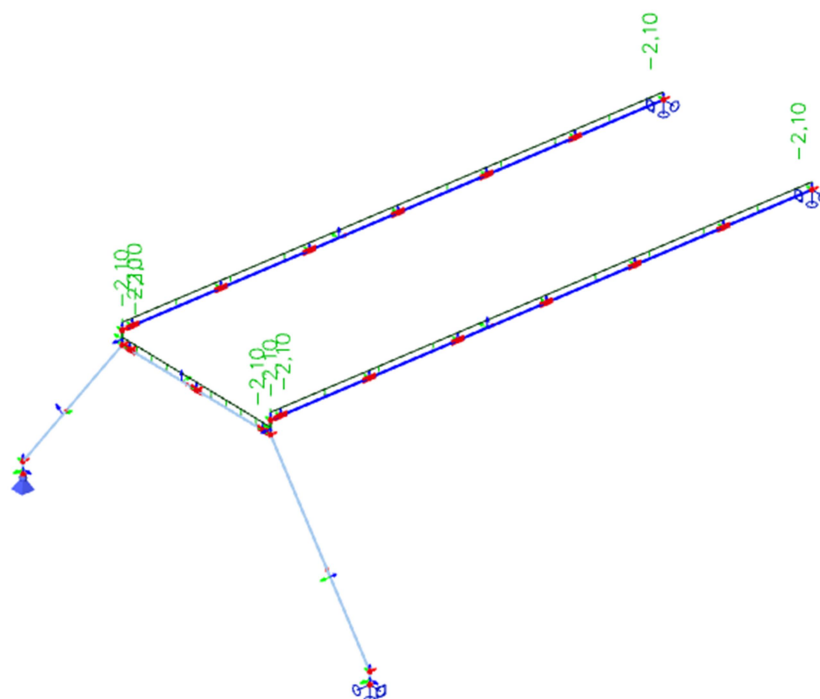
Konstrukce 1a, Zatěžovací stav ZS4
